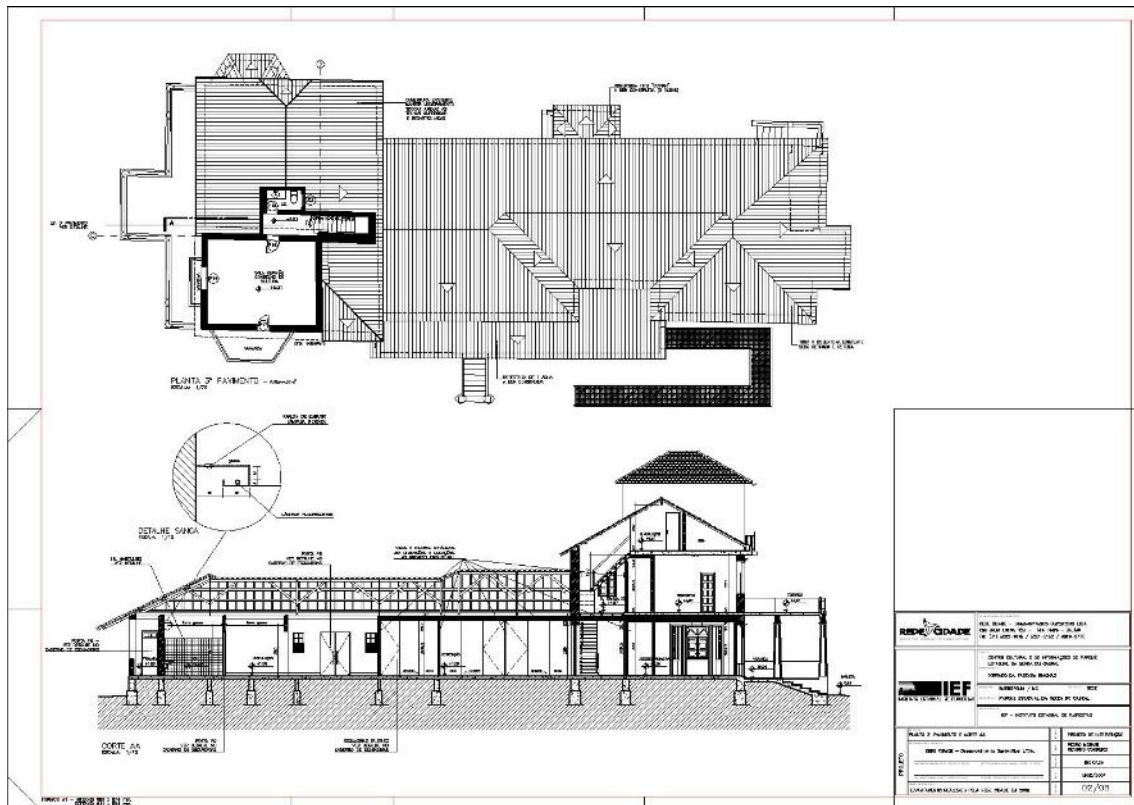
Reprodução Projeto Intervenção. Planta 3º pavto e Seção Longitudinal. Fonte: IEF, 2007.
